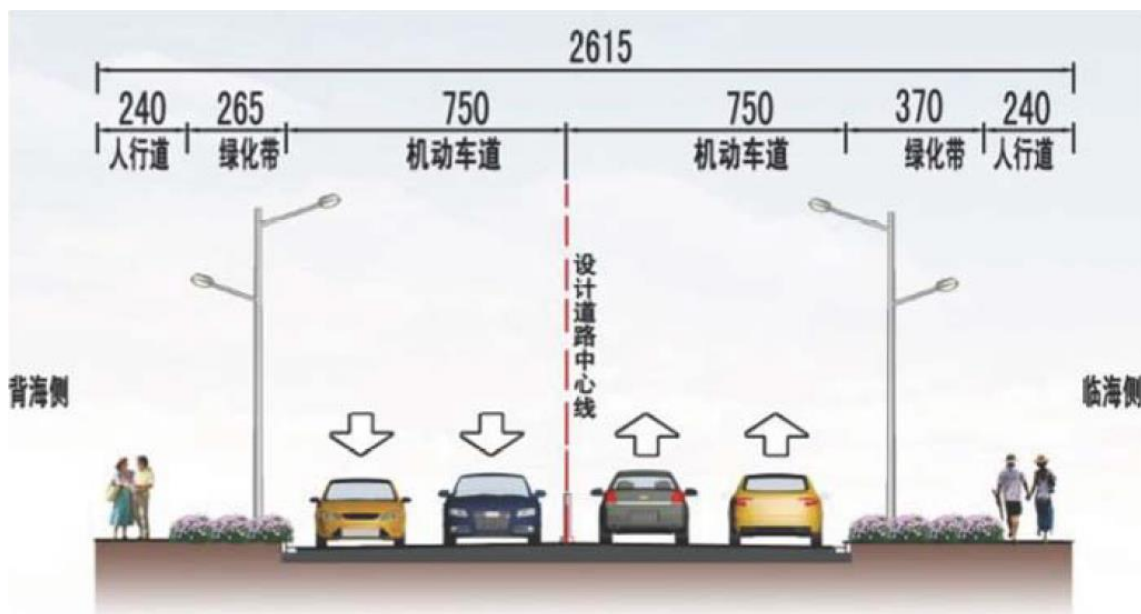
原西大堤(海滨大道~神州宾馆)段现状横断面布置图
